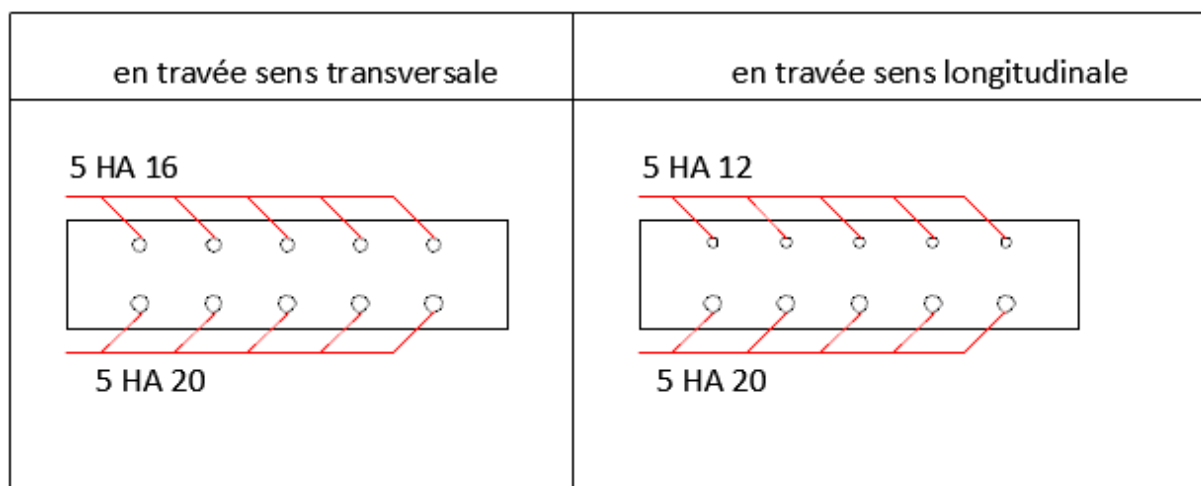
plan ferrailage d'1m de dalle en travée
